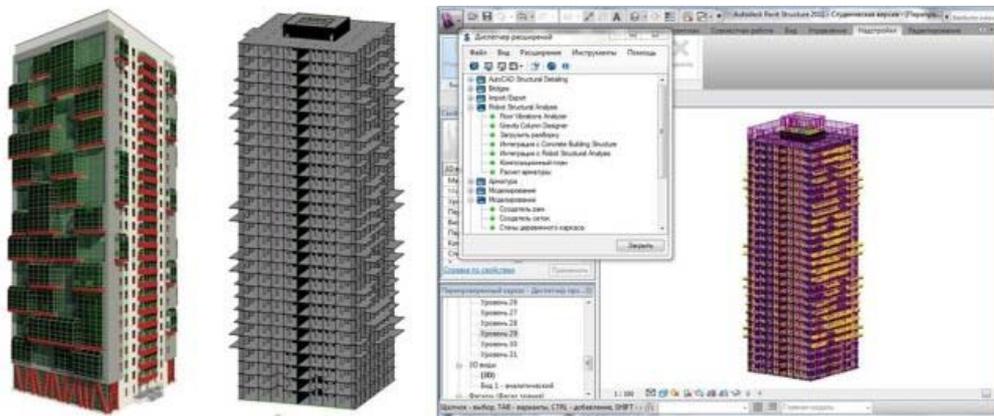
Кристина Ритерман. Проект 25-этажного жилого дома. Показаны общий вид здания и его железобетонный каркас. Справа – другой вид единой модели (каркас с заданными нагрузками). Работа выполнена в Revit Architecture, Revit Structure и Robot Structural Analysis. НГАСУ(Сибстрин), 2011.
